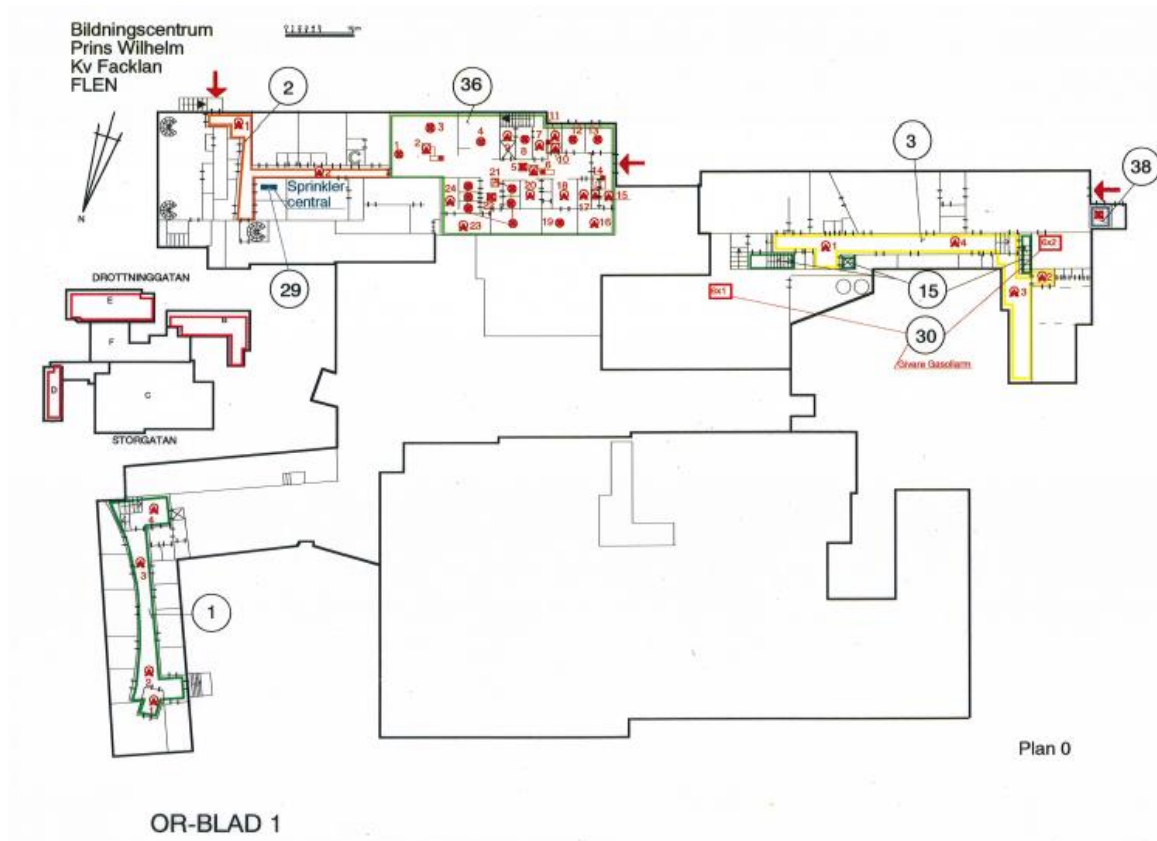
Rödmarkerat området visar sprinklersystem på plan 1
